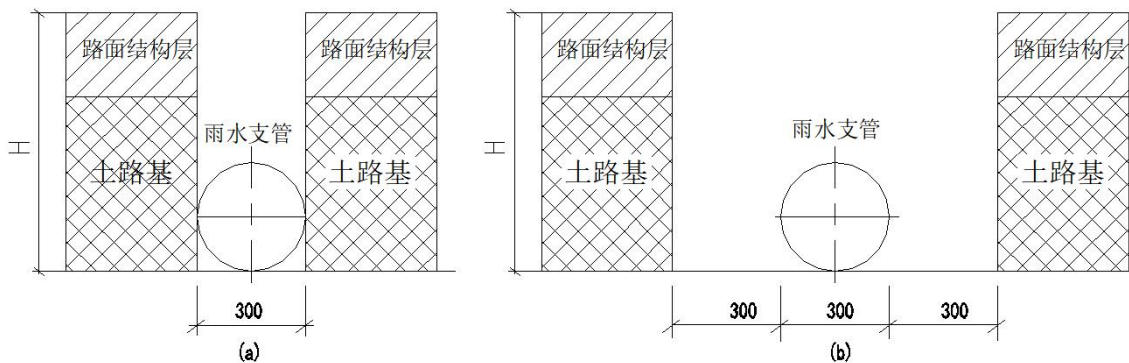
雨水支管沟槽开挖断面示意图 (单位: mm)
